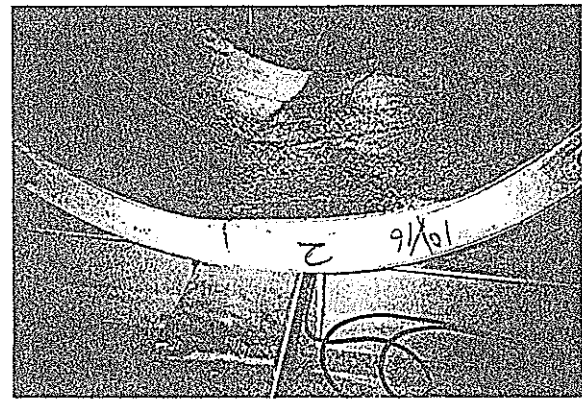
炭素繊維シートを内貼りしたヒューム管の破壊状況
